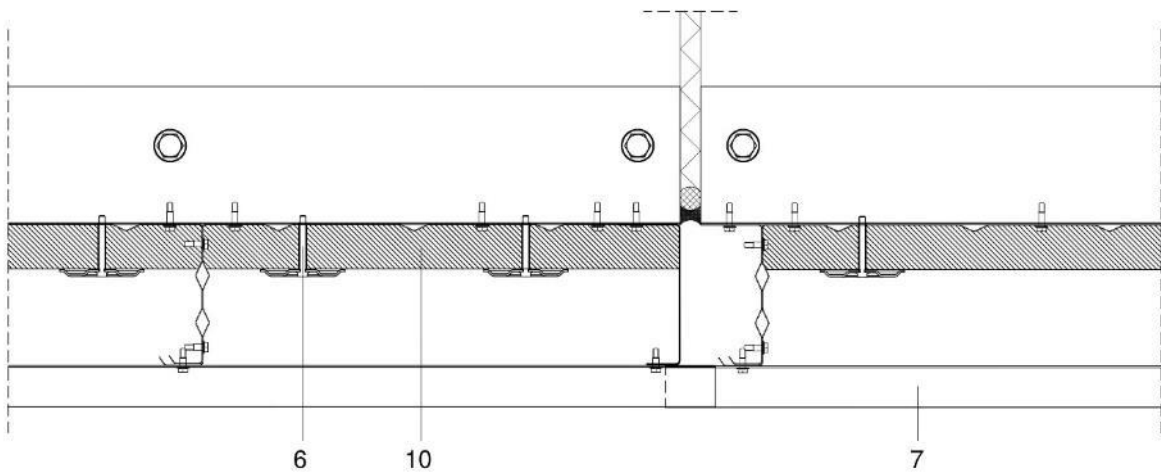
b: Detalle de junta de dilatación con aislamiento térmico.
